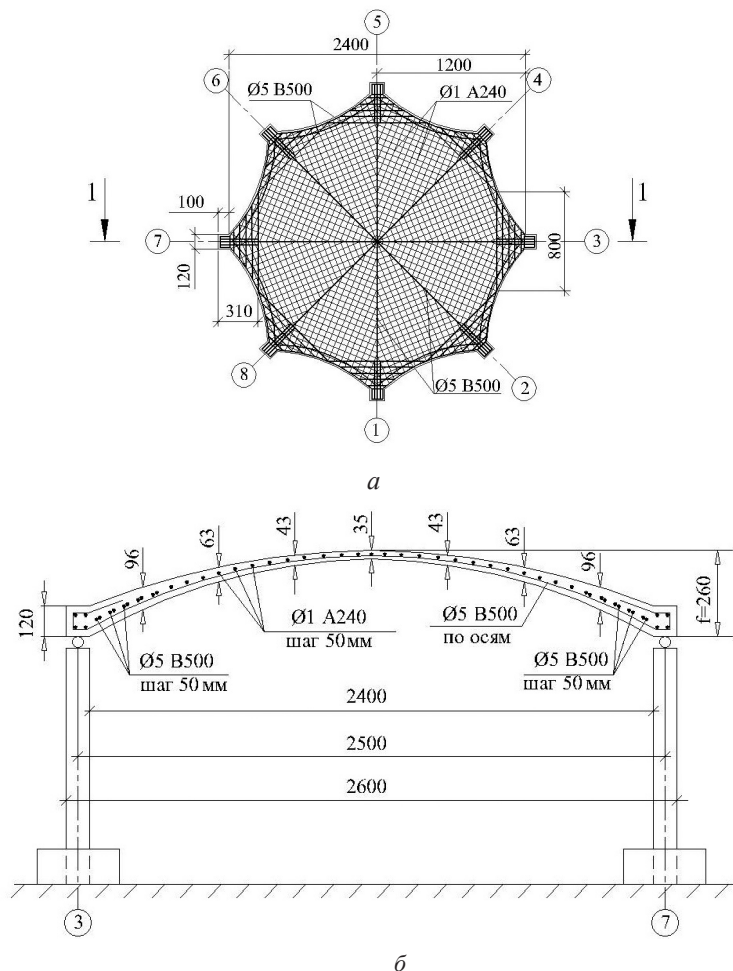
Испытанный зонтичный купол на конструкции малых размеров:
